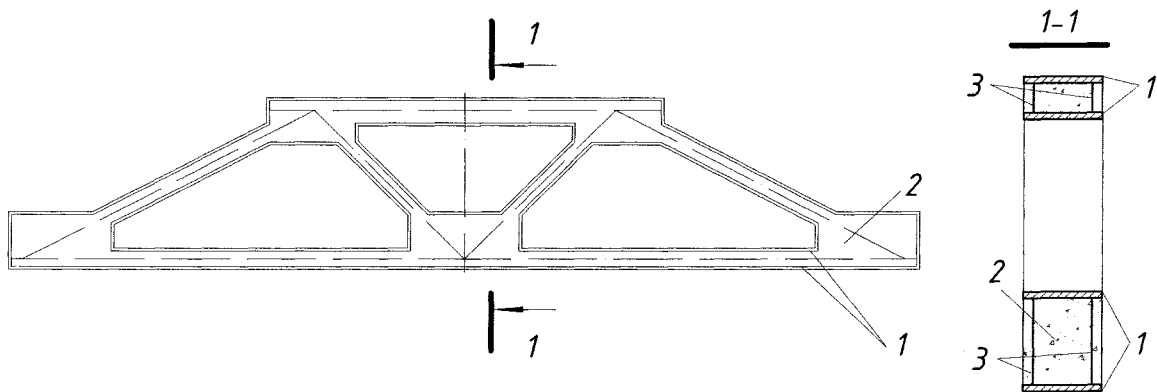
Підкроквяна ферма із зовнішнім листовим армуванням
